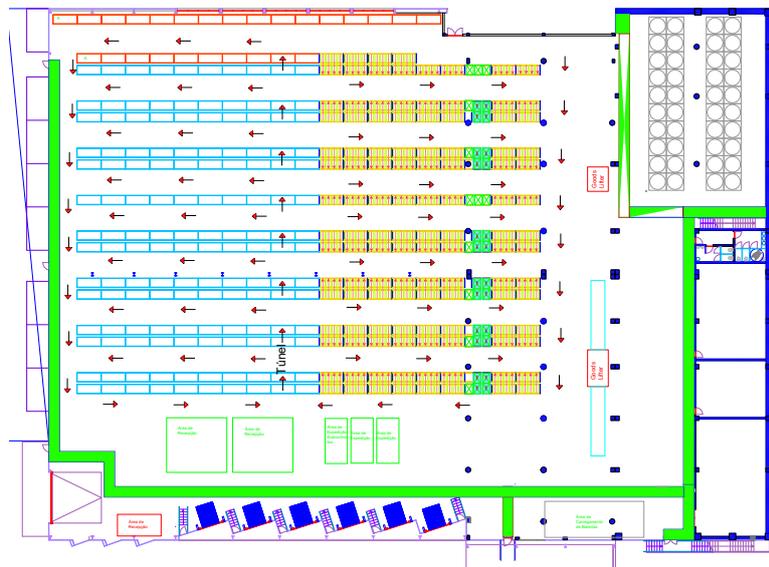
Planta Armazém com implantação de áreas de *picking* e armazenagem
